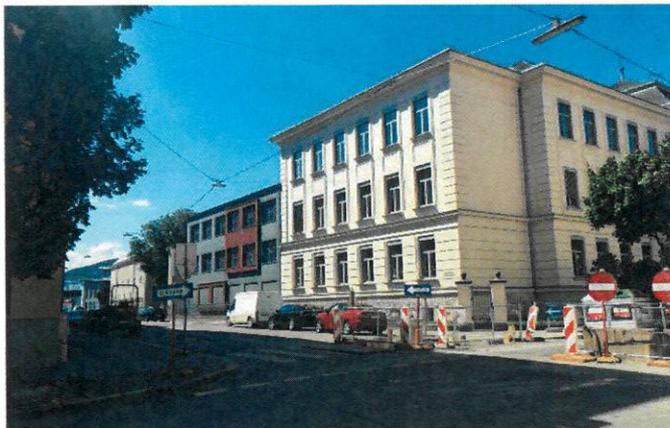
Im Kreuzungsbereich Oeverseegasse / Custozzagasse. Blick in nordwestliche Richtung.
